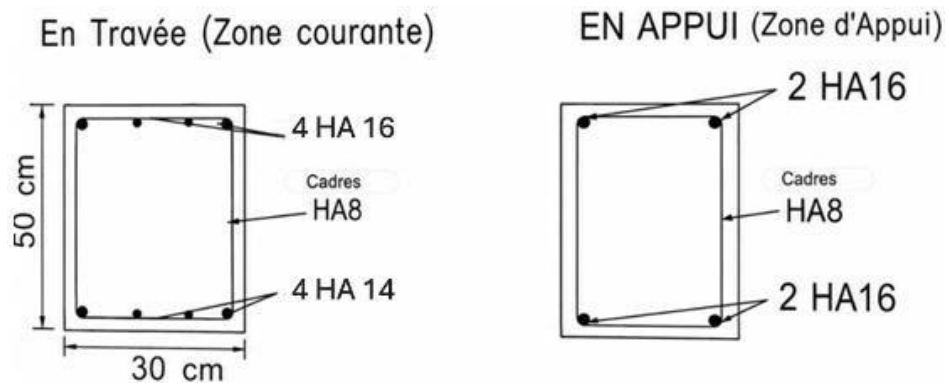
Dessin Ferrailage coupe transversale(P2).
